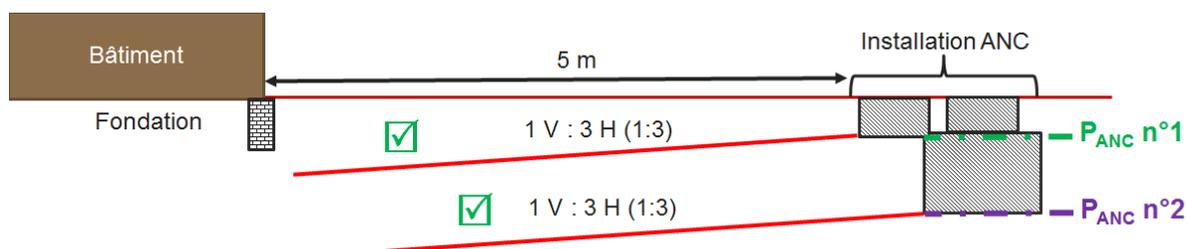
Ecarts minimum entre fondation et installation d'ANC.
